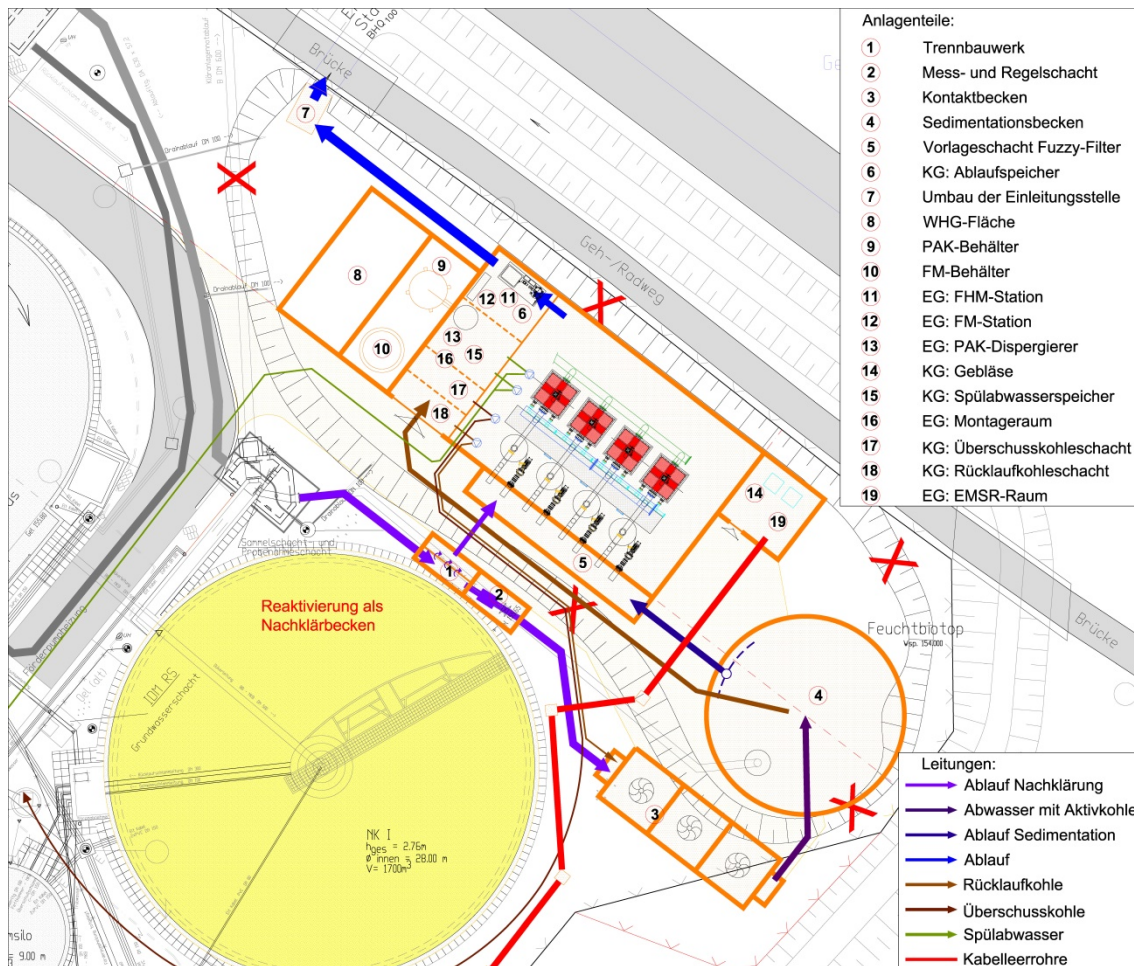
Lageplan KA Barntrup - Variante IIa - PAK-Stufe mit Sedimentationsbecken (Neubau)
